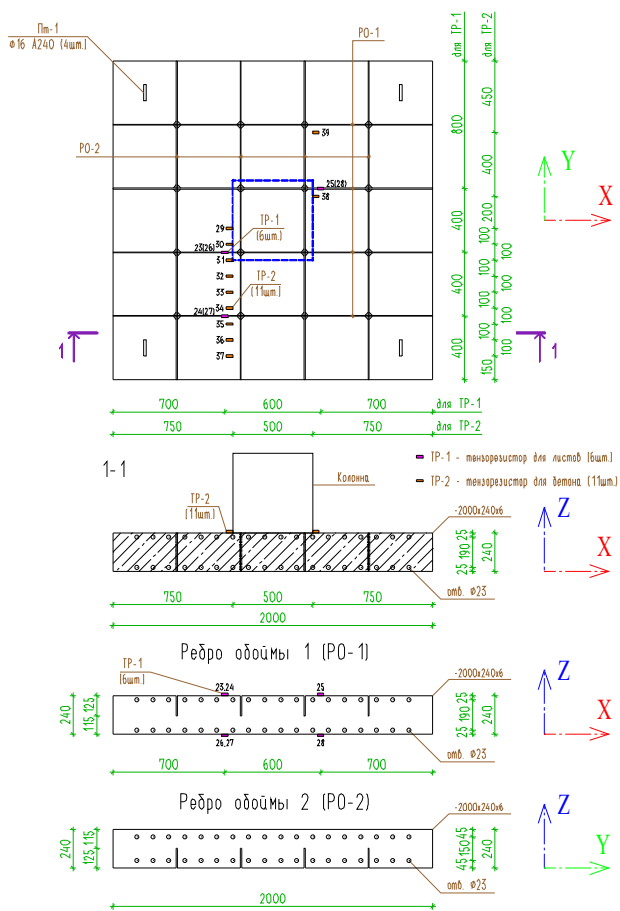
Фрагмент плиты перекрытия 1 (ФПП-1), РС61
